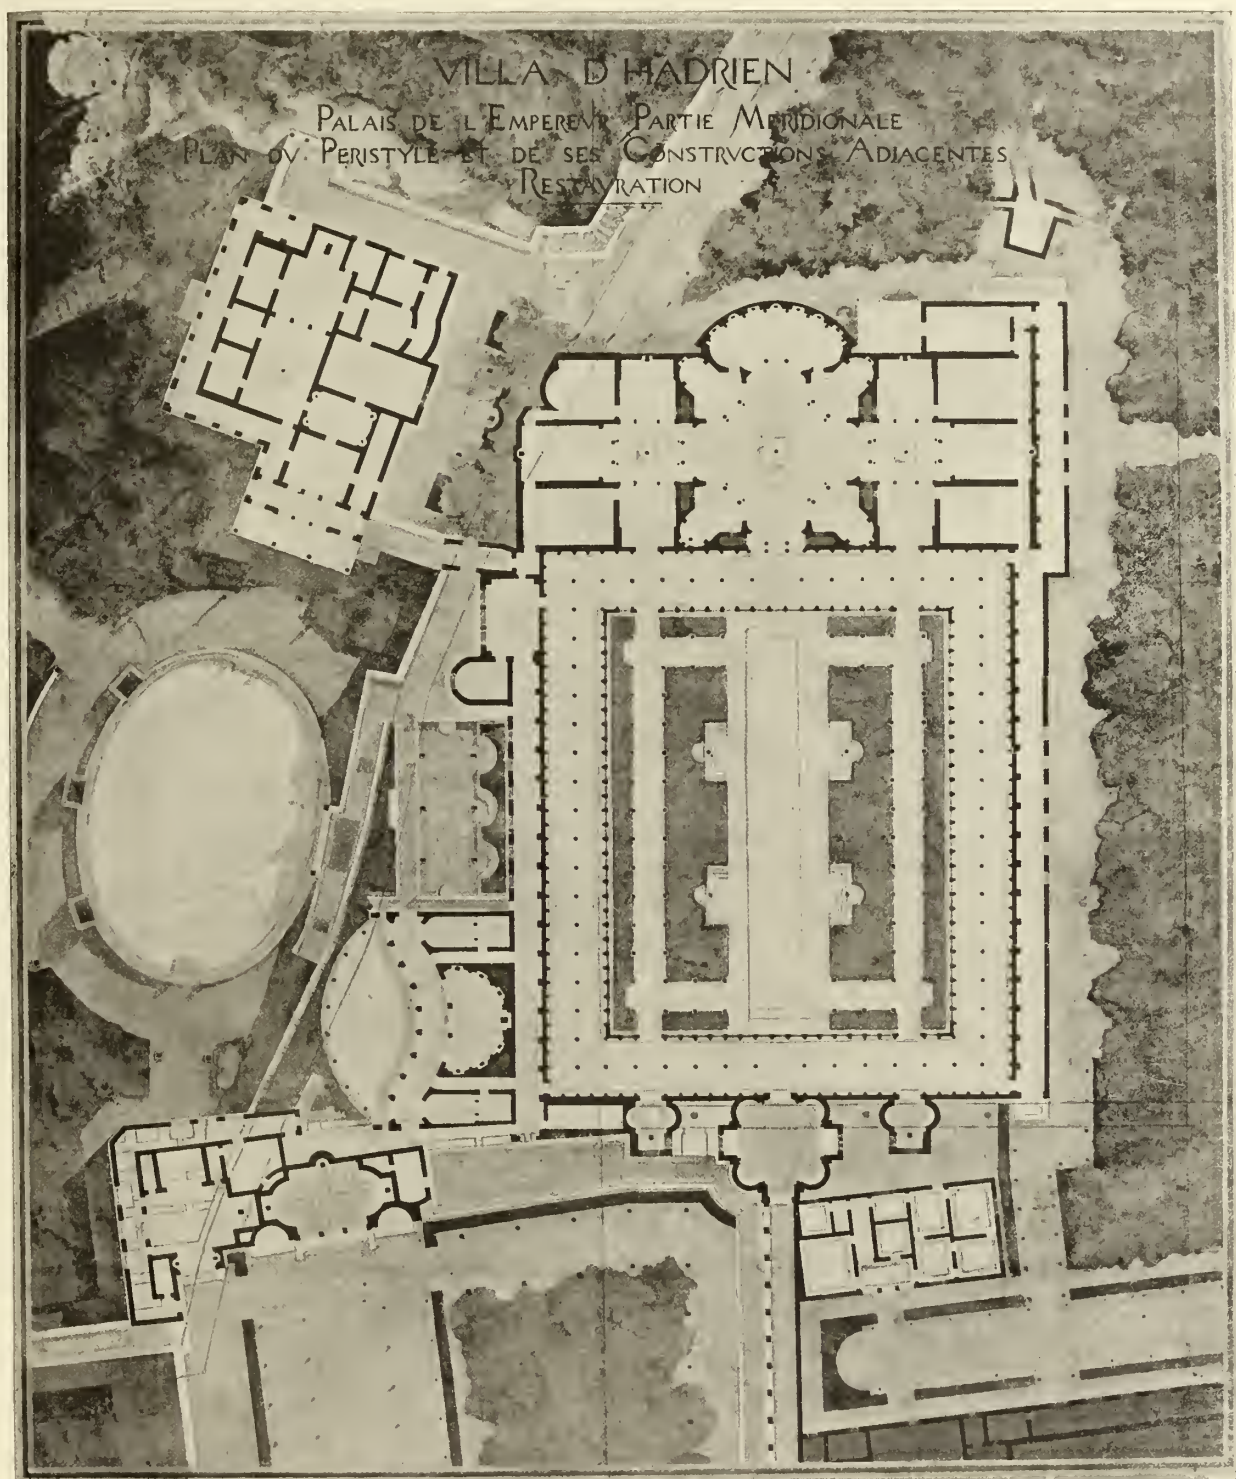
PLAN RESTAURÉ DE LA PIAZZA D'ORO, PAR M. GIRAULT.
